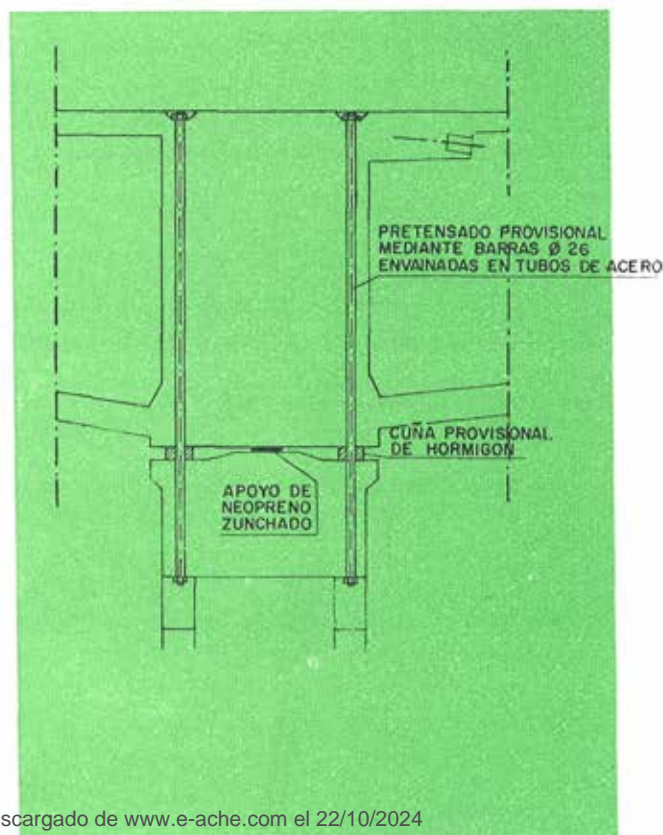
Empotramiento provisional de la dovela situada sobre la pila.
